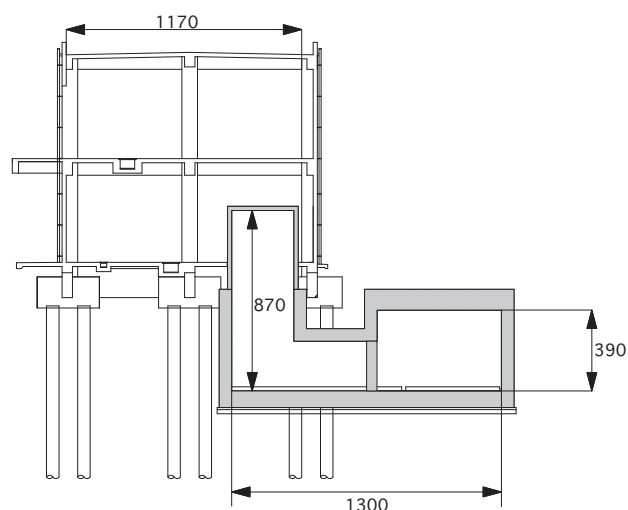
断面図 : DR 電源棟地下 1 階主要部
